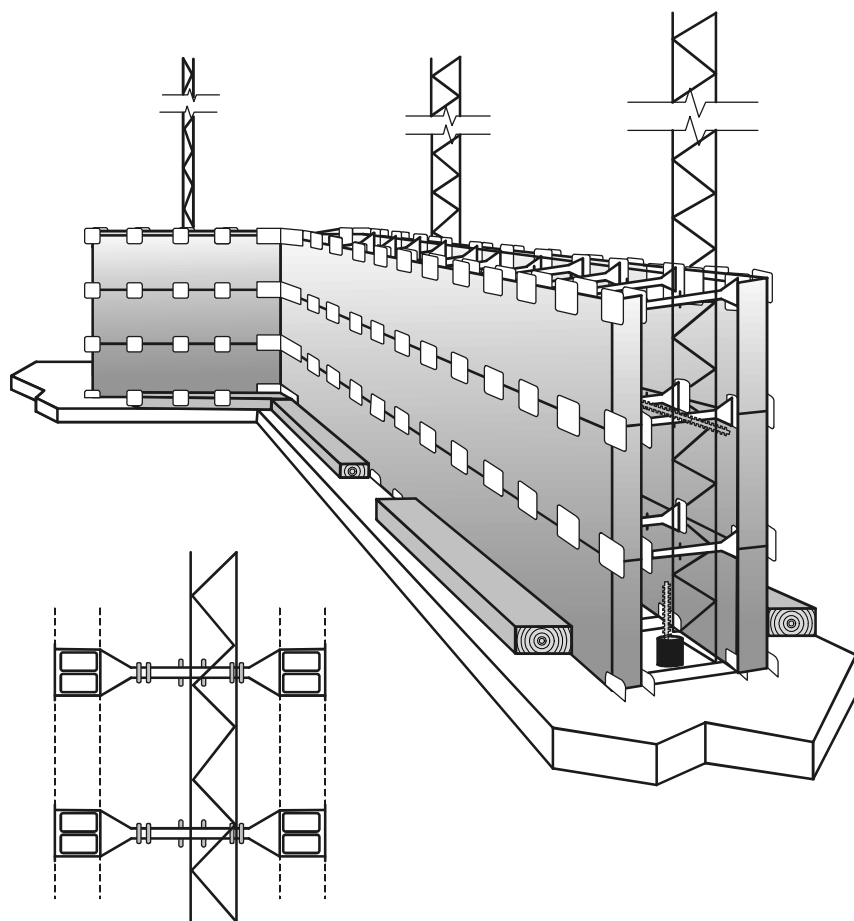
Установка опалубки и арматуры первого яруса бетонирования (стойки и горизонтальные прогоны крепления не показаны)
